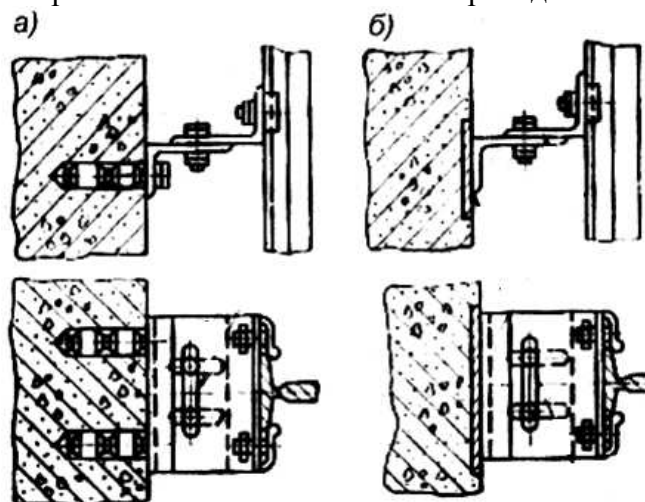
Схемы крепления кронштейнов к стенам шахты
